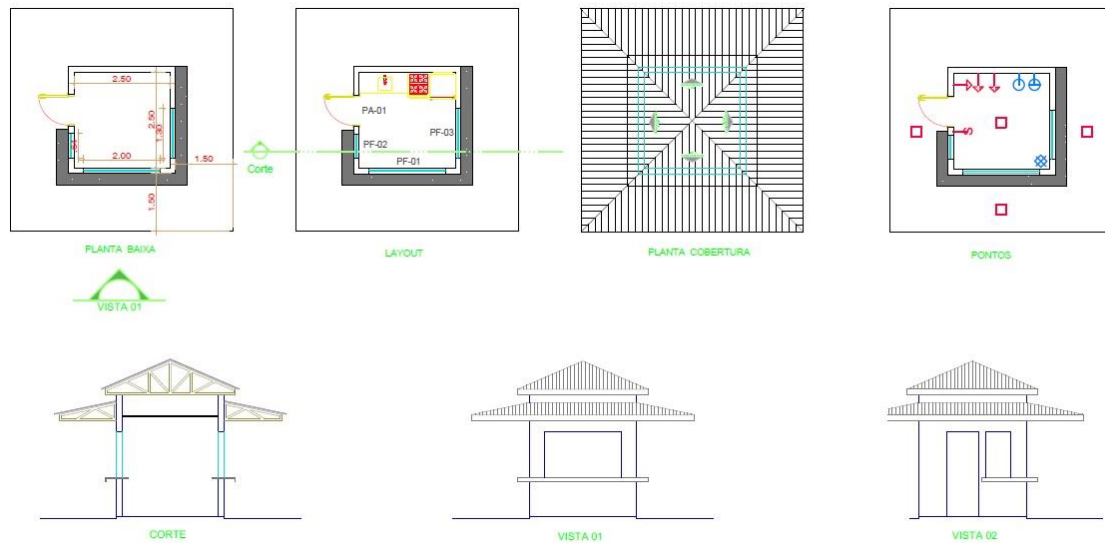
Layout da implantação do projeto de revitalização do Balneário Pau Cheiroso
